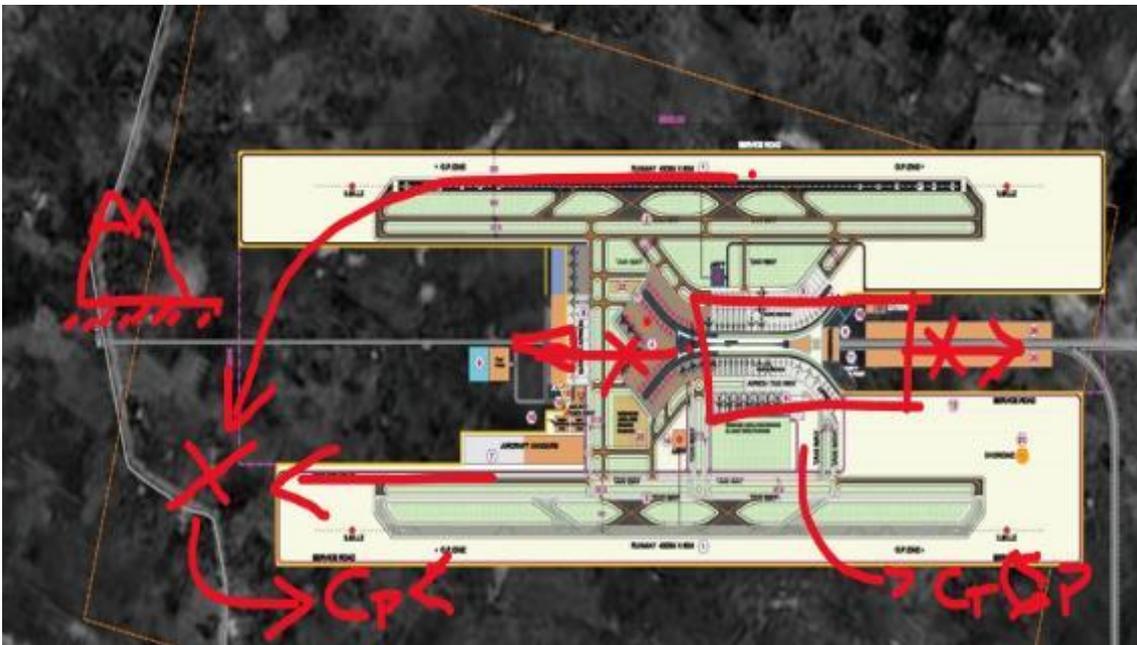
Plano revisado por la contraparte con los signos que explican su réplica
